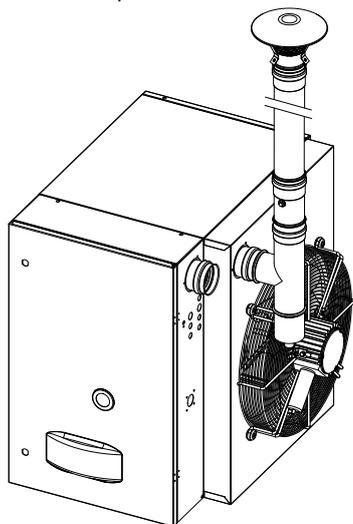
Installazione tipo B22 con tubo fumi a parete
